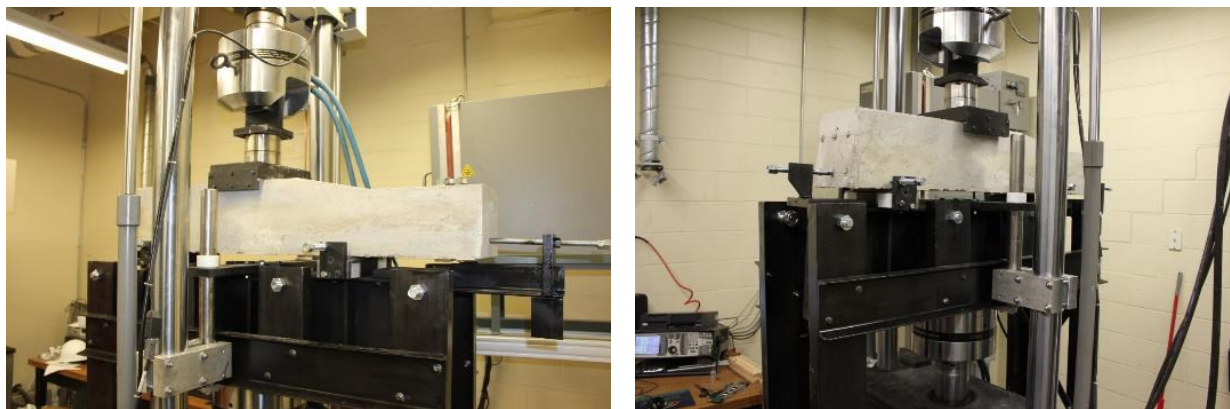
Montage de l'essai de fatigue et spécimen en place
